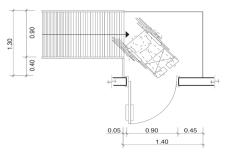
Planta de Rampa e Ingreso. CONADI 72.
